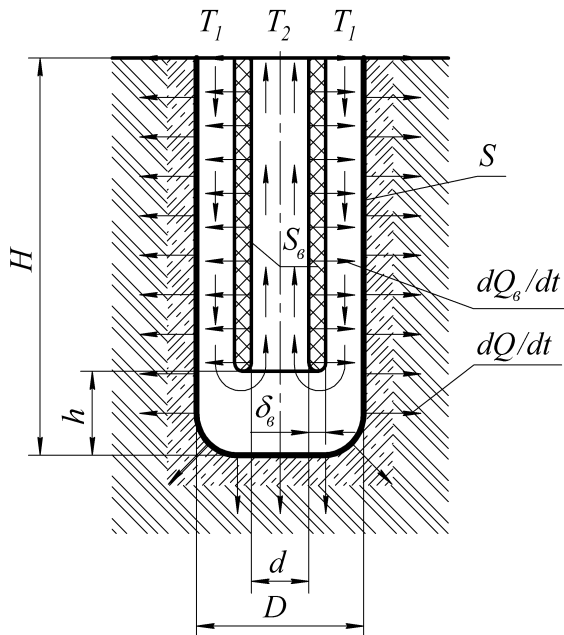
Подовжній переріз ґрунтового теплообмінника
